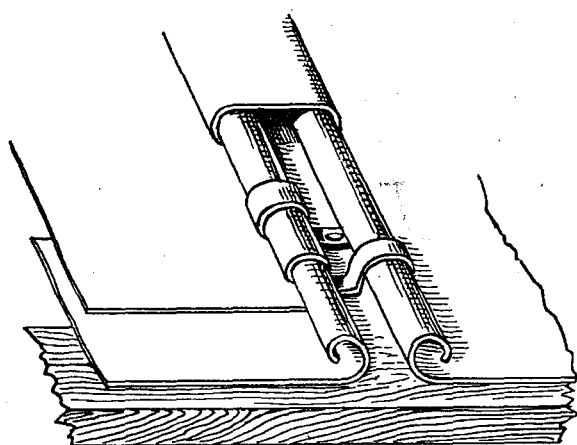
Unión de las planchas de cobre, en una cubierta de este metal.
